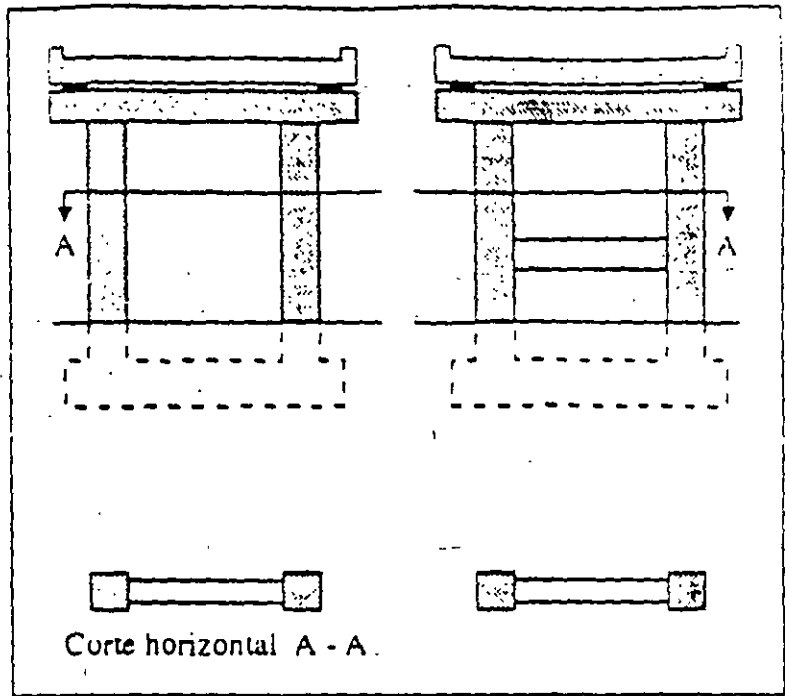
Pila, tipo 33, 2 o más columnas con cabezal común y diafragma (o vigas horizontales)
